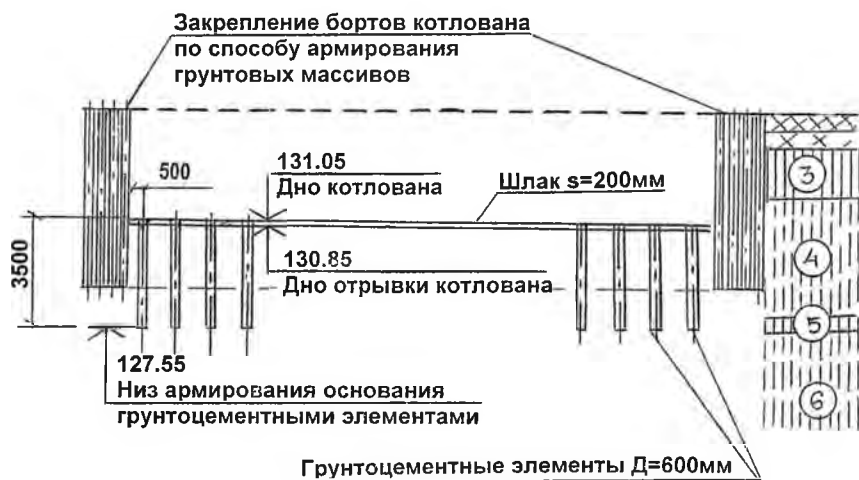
Схема выполнения работ по закреплению бортов котлована и основания плитного фундамента.
